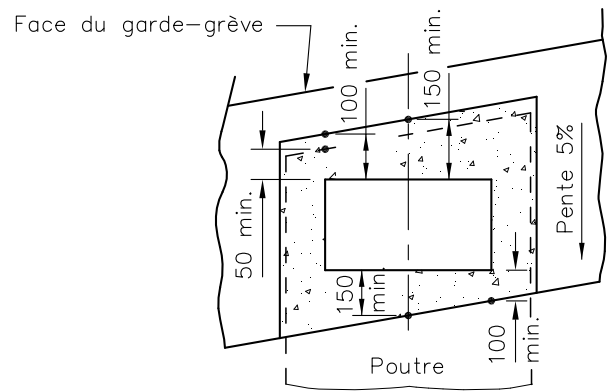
Bloc d'assise d'un appareil d'appui (Extrémité de la dalle sans joint de tablier)
